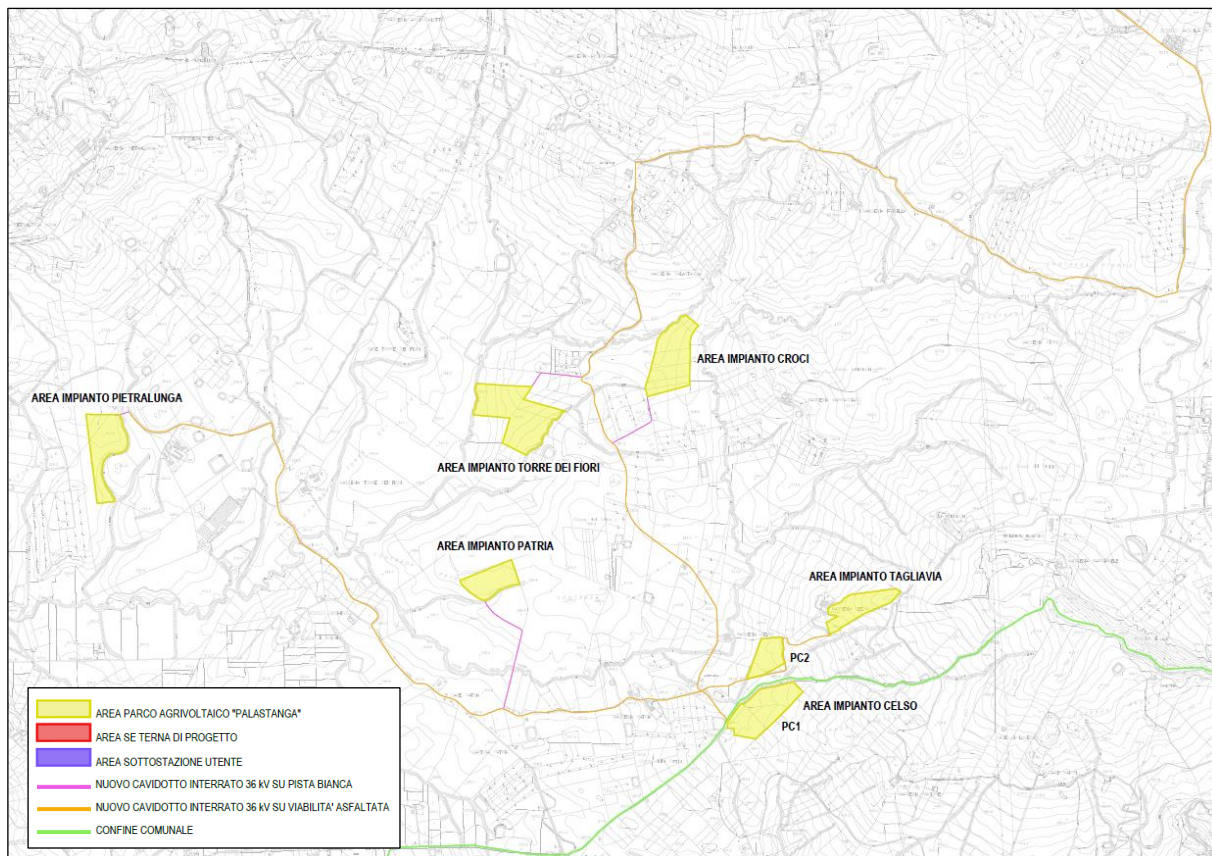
Inquadramento opere in progetto (impianto) su CTR (Scala 1:10000)
